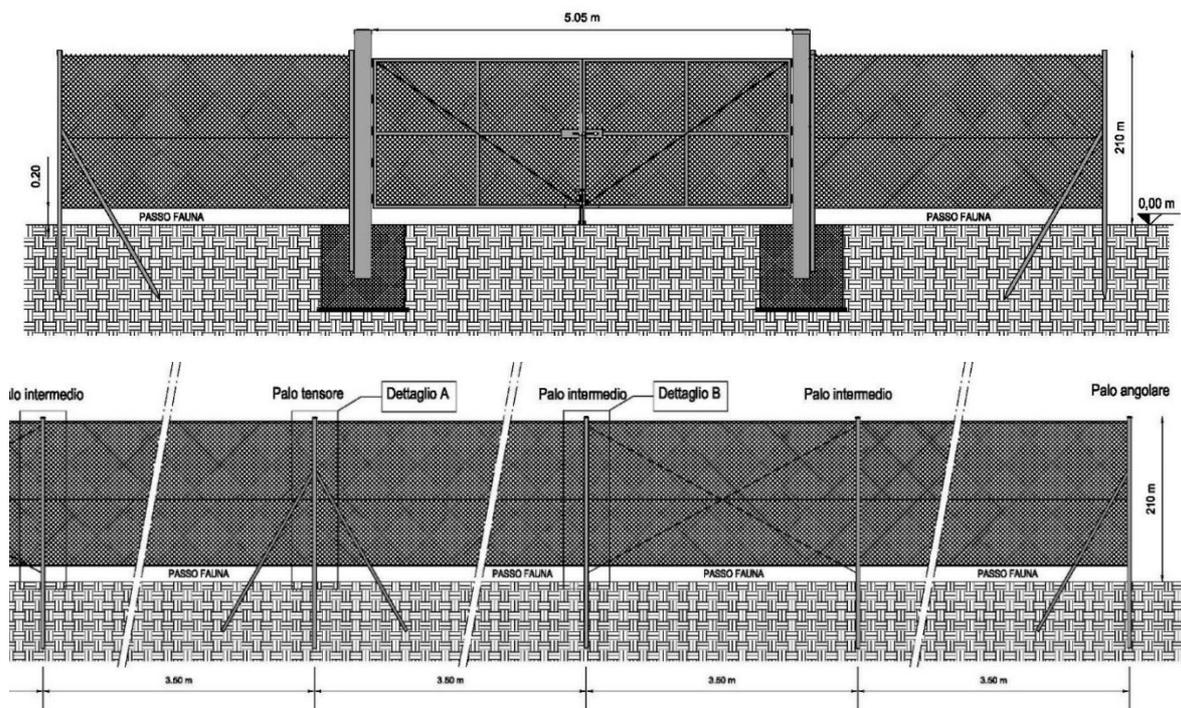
Planimetrie di progetto recinzione e cancello.
